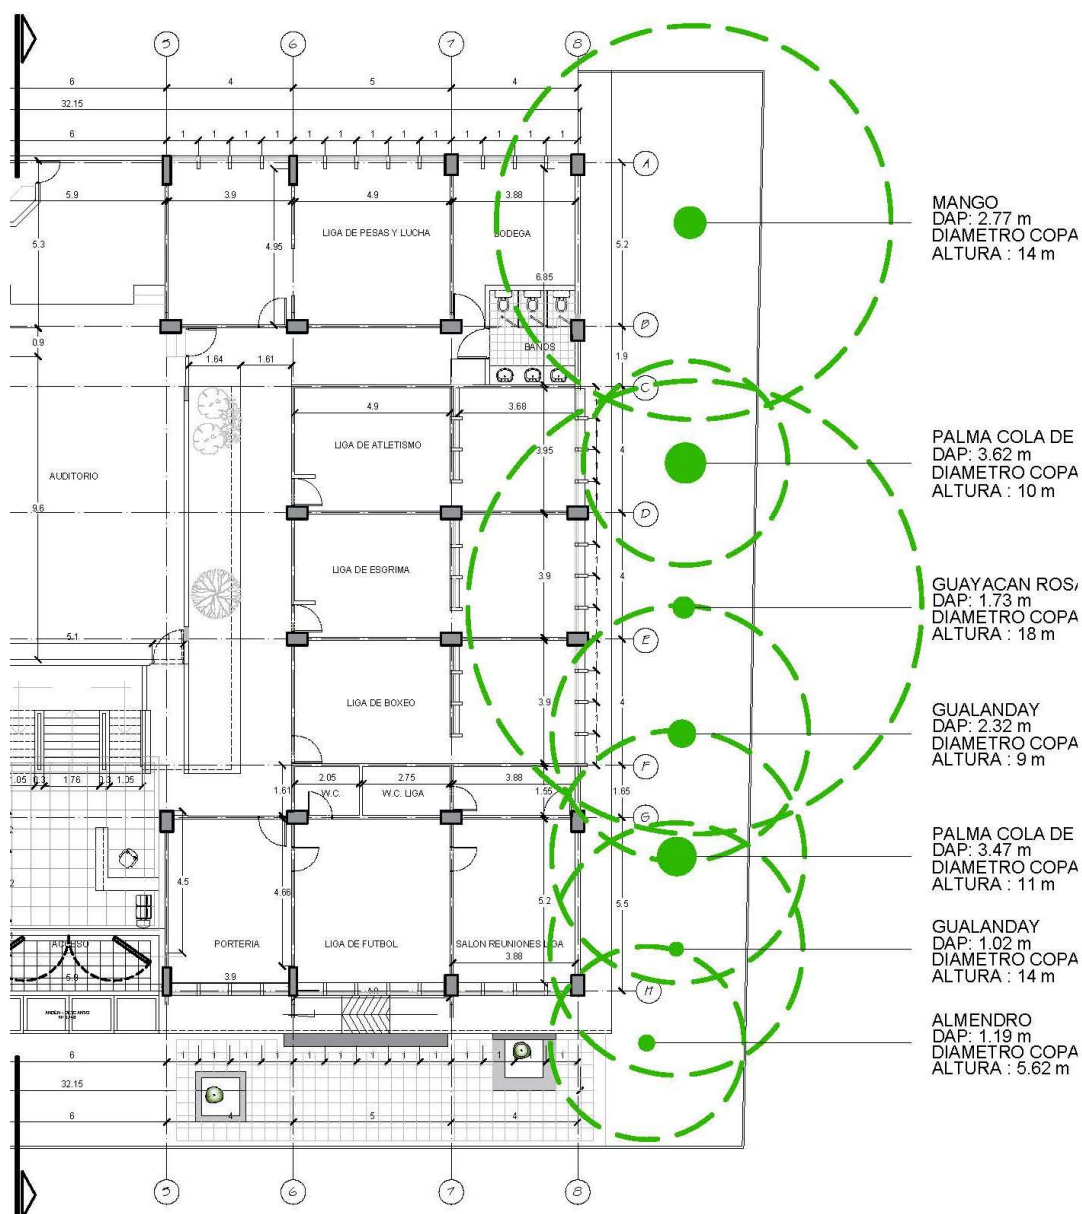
Ubicación en planta de los 7 árboles en la fachada sur-oriental del edificio
